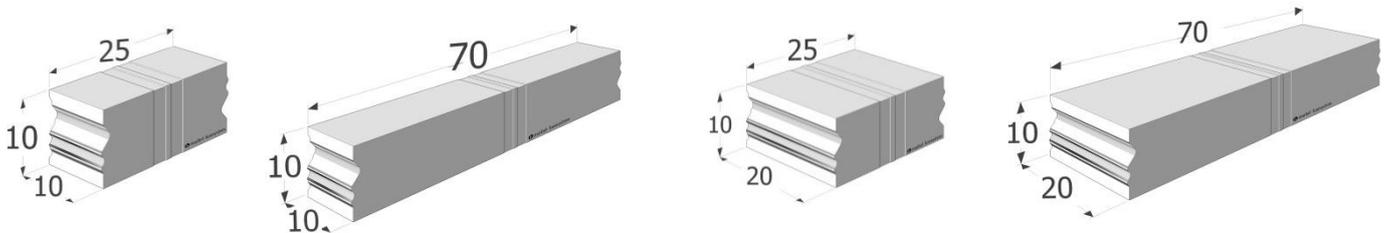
Typen des Wärmedämmenden Montagebalkens (Erweiterung der Laibung um 10 oder 20 cm)
